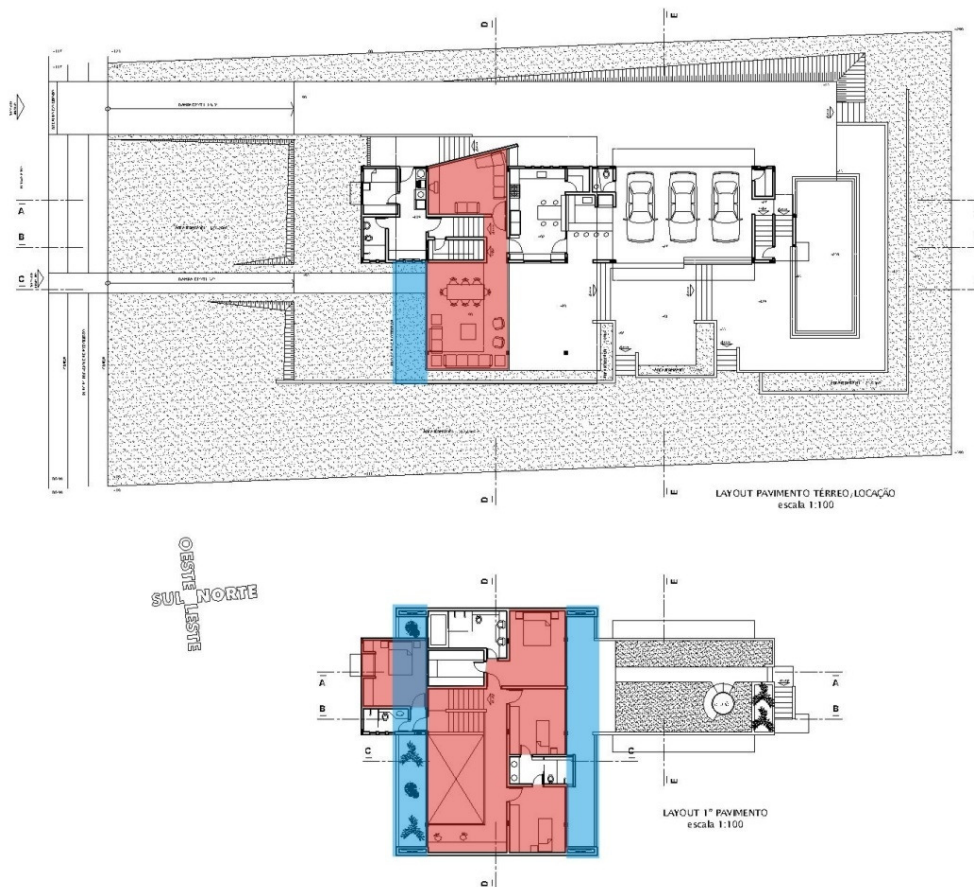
Projeto 1 - Setorização e Beirais - Plantas
